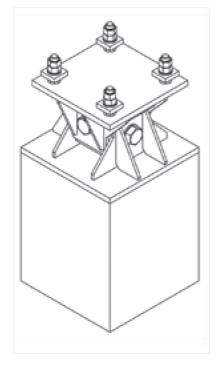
Схема шарнирного узла для крепления опоры ВЛ к фундаменту
